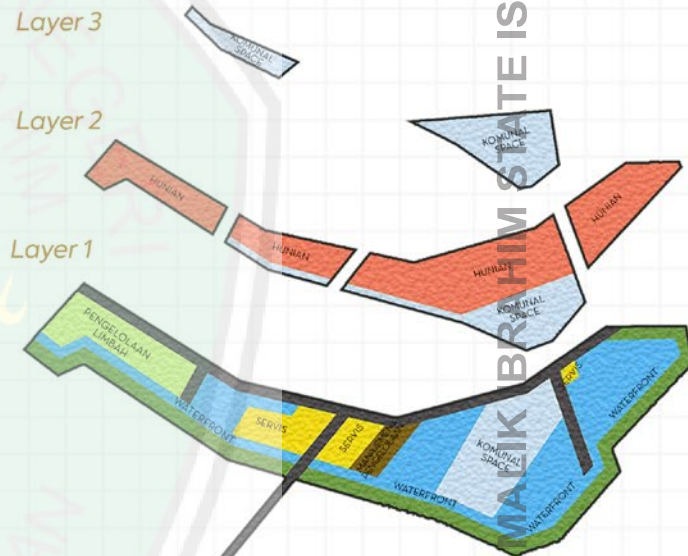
KeyPlan Area Pembangunan Pada Tapak
